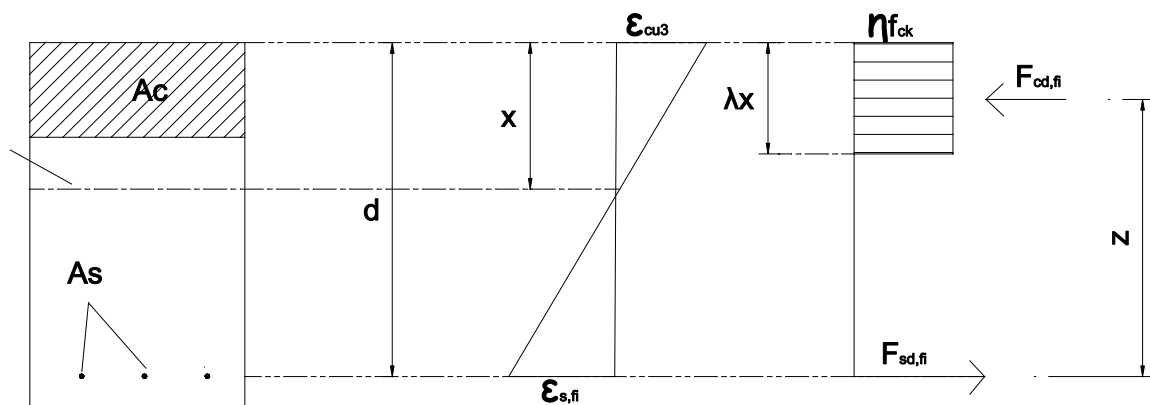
Розрахункова схема зусиль у перерізі з/б плити перекриття
